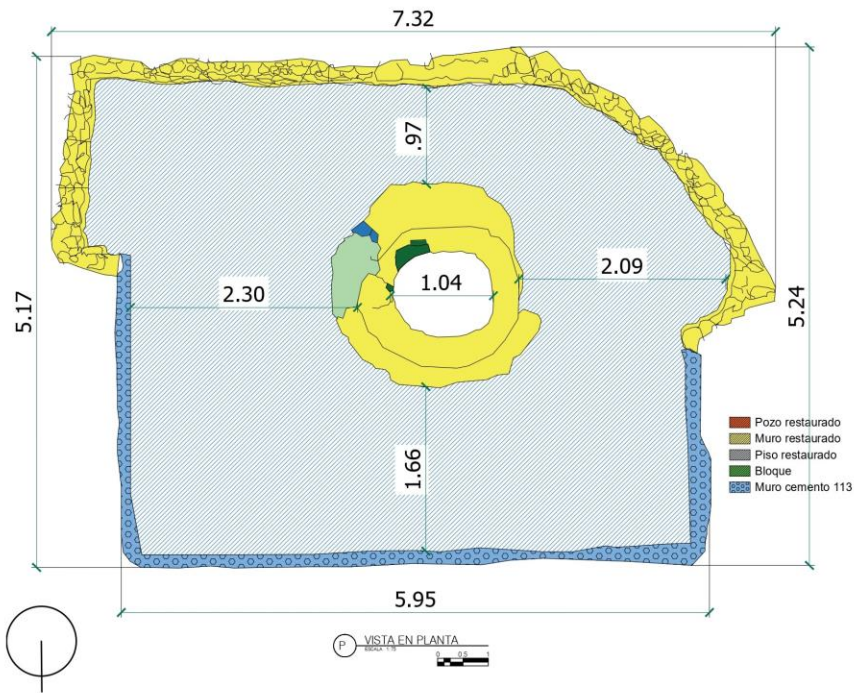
Levantamiento planimétrico del Aljibe
